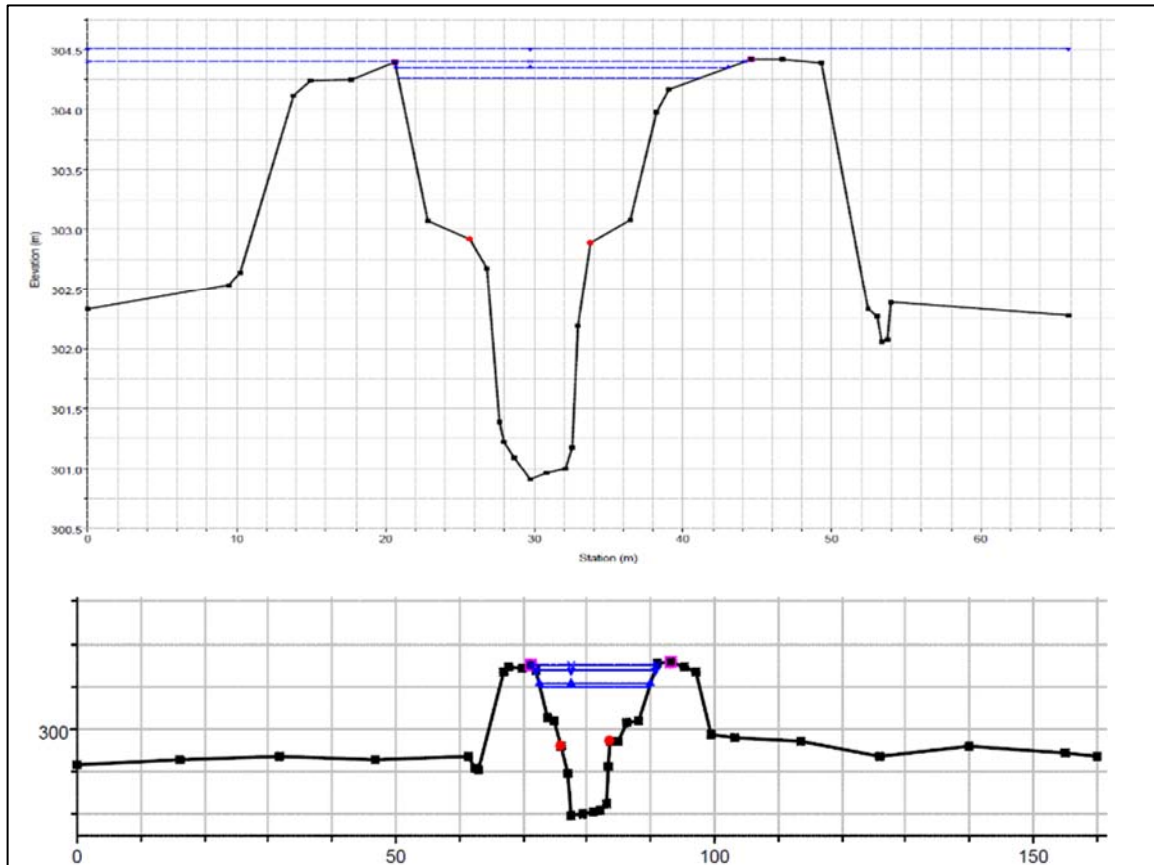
/C – Sezioni idrauliche sez. 01 (in alto) e sez. 0 (in basso), rispettivamente a monte e a valle dell'attraversamento
